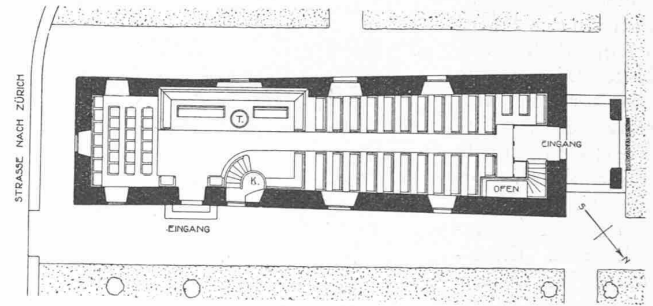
Ostansicht des alten Kirchleins in Fällanden bei Zürich. — Abb. 2. Grundriss 1:300.
